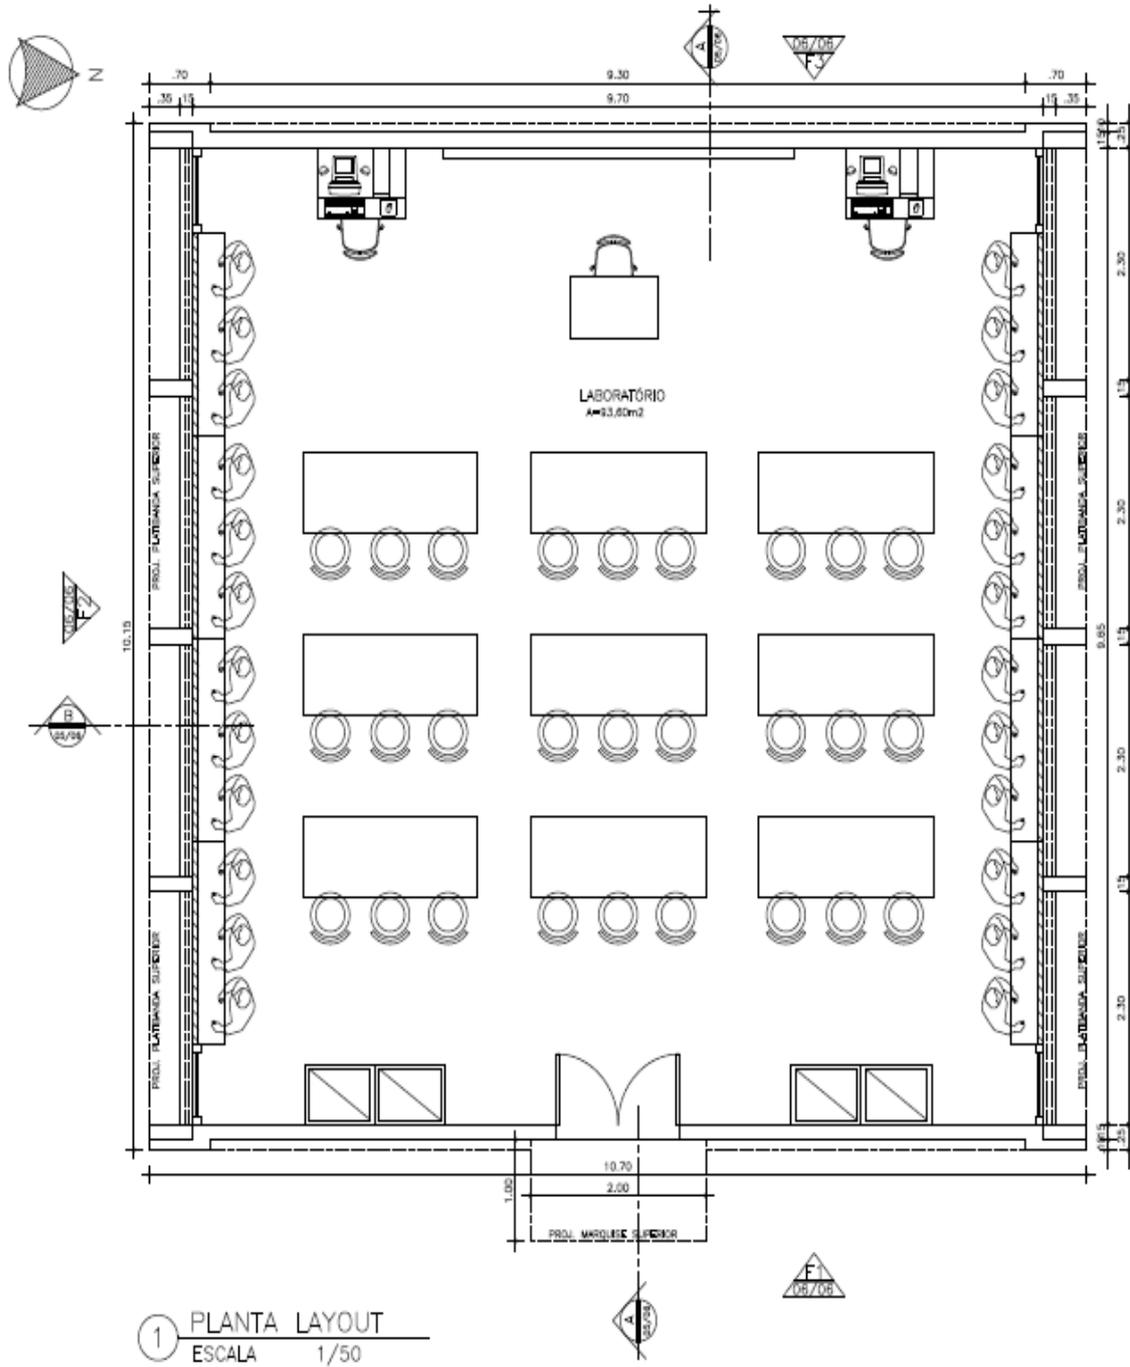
Planta de layout do projeto original do estudo de caso. (Fonte: COP/UFC)
